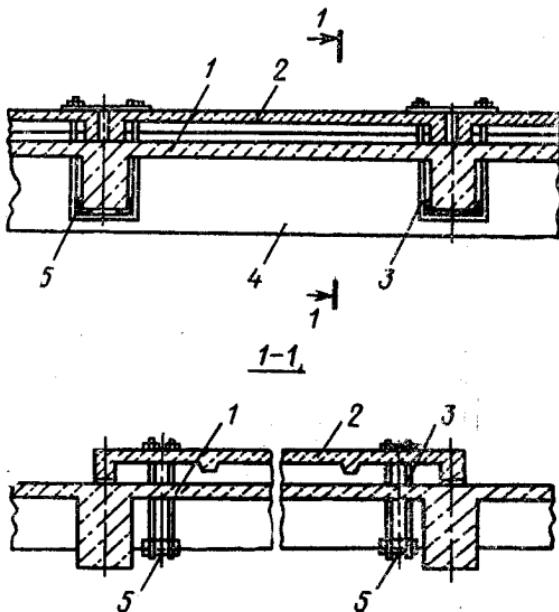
Разгружение монолитной железобетонной плиты ребристой железобетонной плитой:
